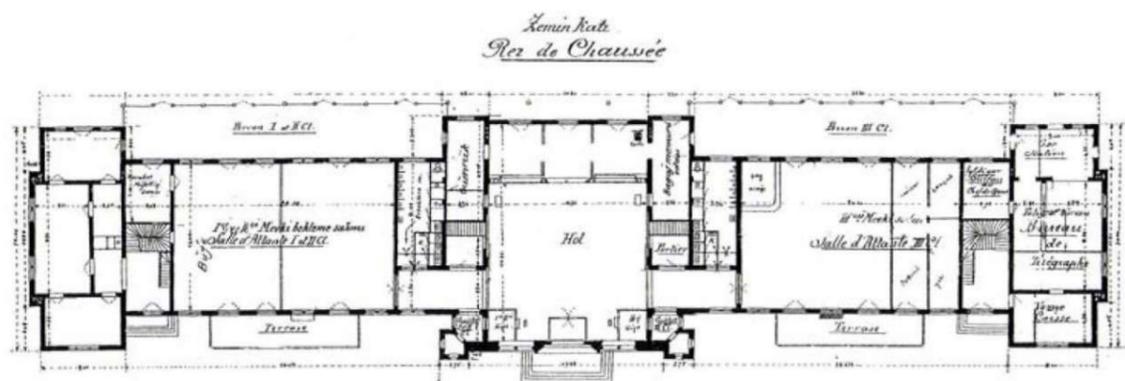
Sirkeci Bahnhof in Istanbul, Grundriss, 1890
